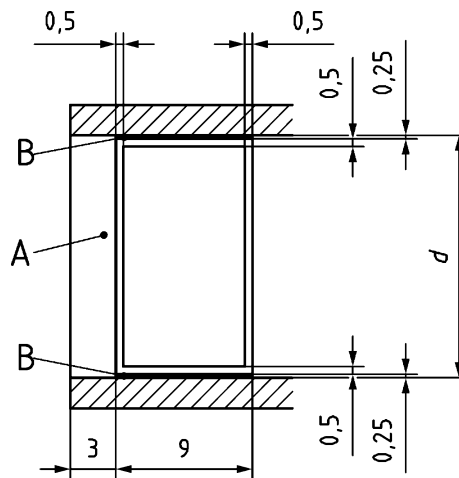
Esquema da seção de perfil com vidro instalado
